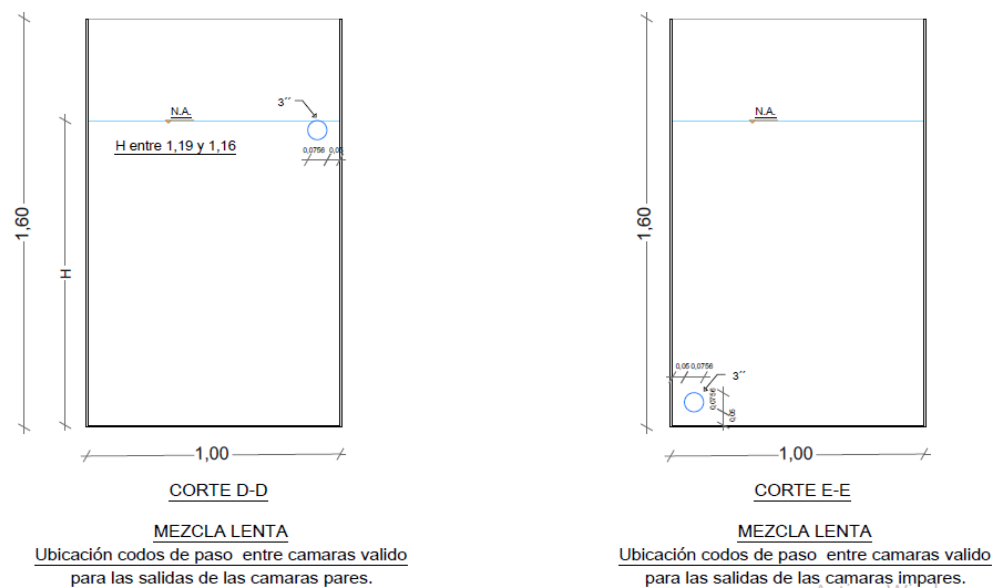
Vista frontal de las cámaras del floculador Alabama propuesto para el tratamiento
